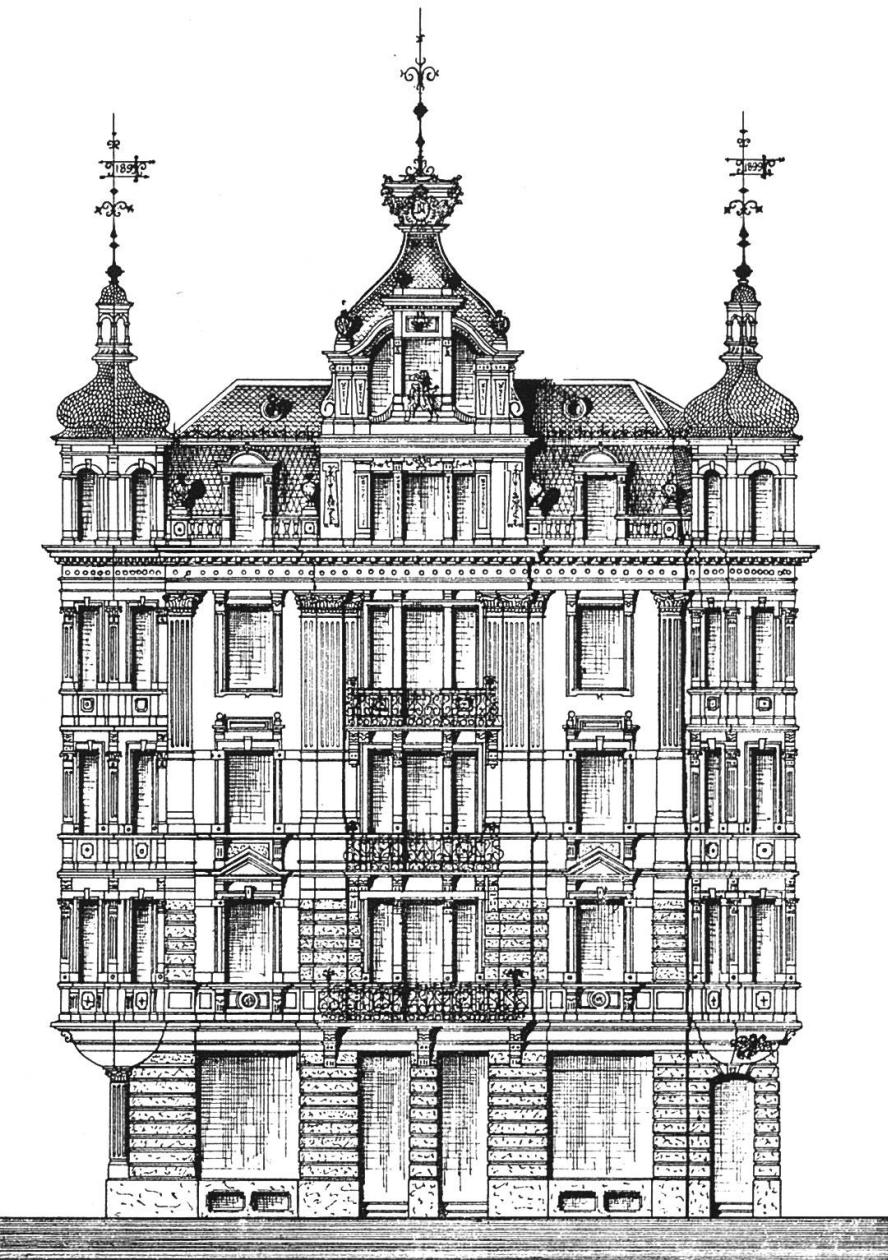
Falkenplatz 24. Detail der Straßenfassade.
